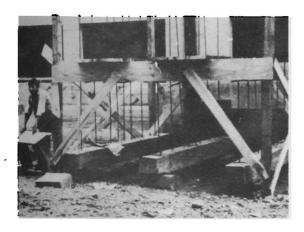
Comienza la construcción de los muros. En la foto: muros de albañilería armada para ensayos de cargas horizontales.
